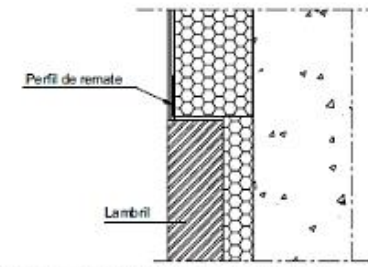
Pormenor da situação existente - ligação ETICS / lambril.
